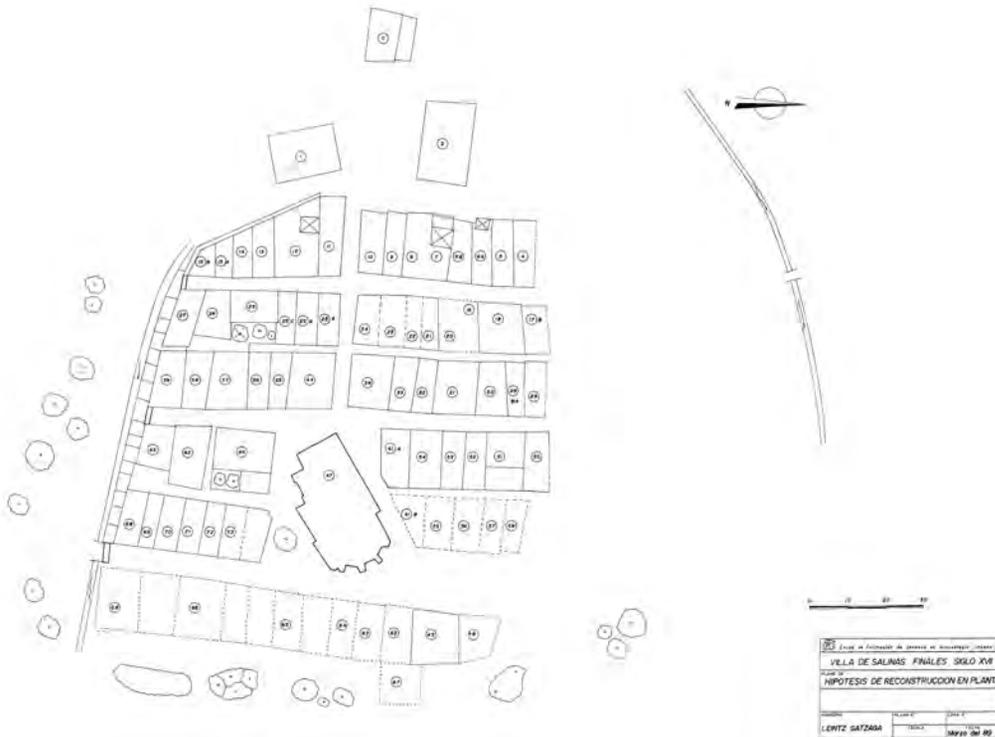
Propuesta de reconstrucción del plano urbano a finales del siglo XVI.
